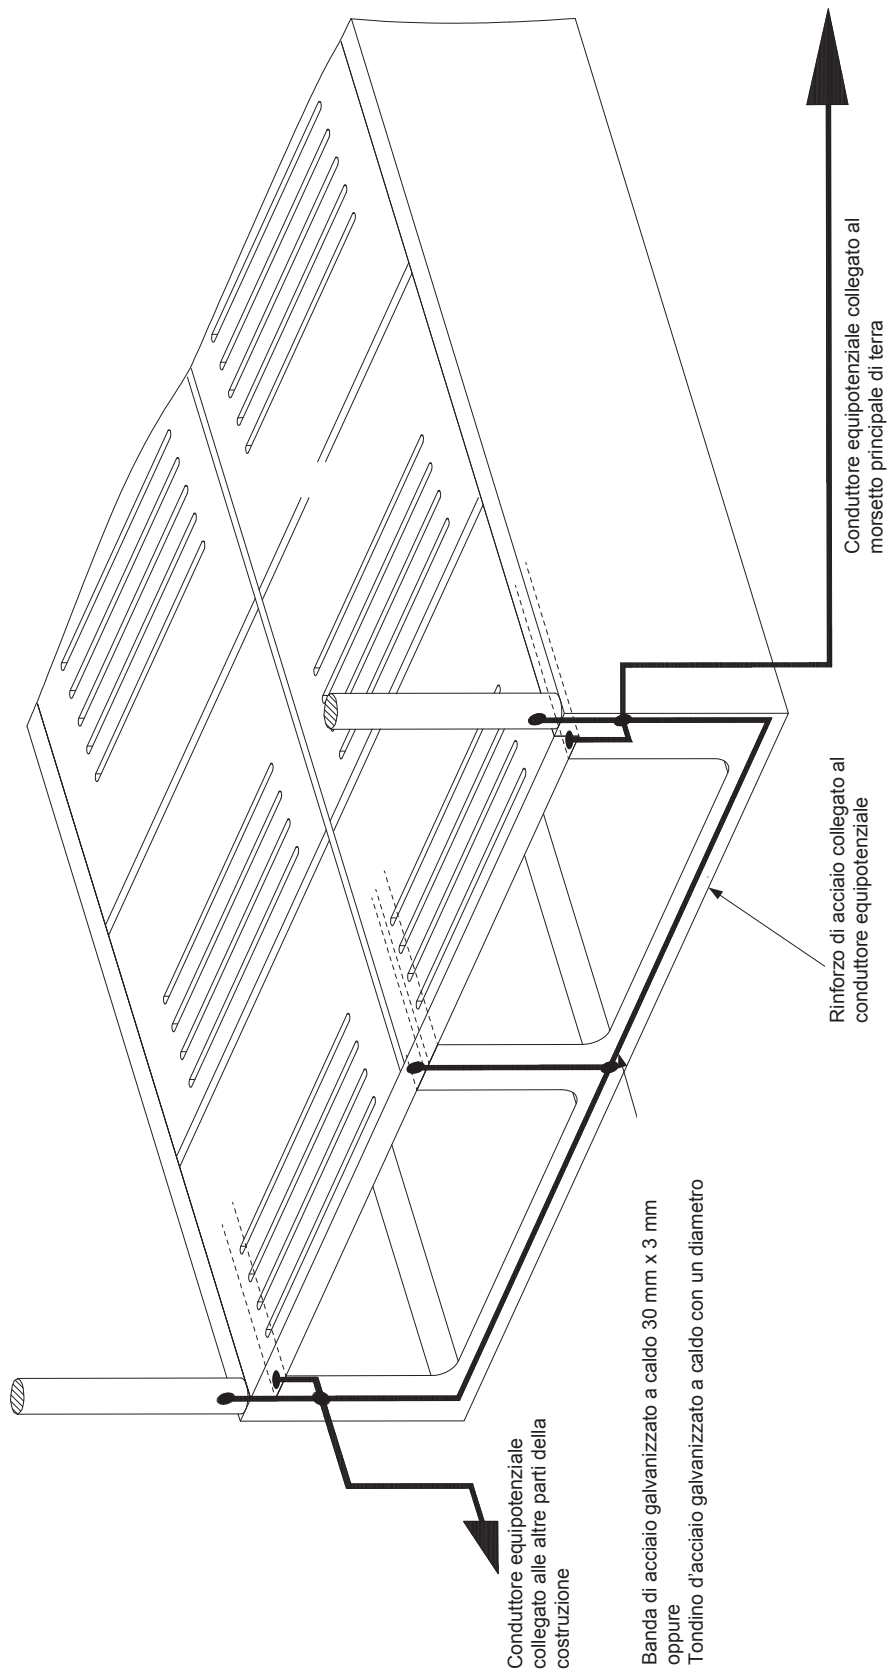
Esempio di collegamento equipotenziale applicato alla costruzione di cemento con pavimento spazato per la raccolta di letame
